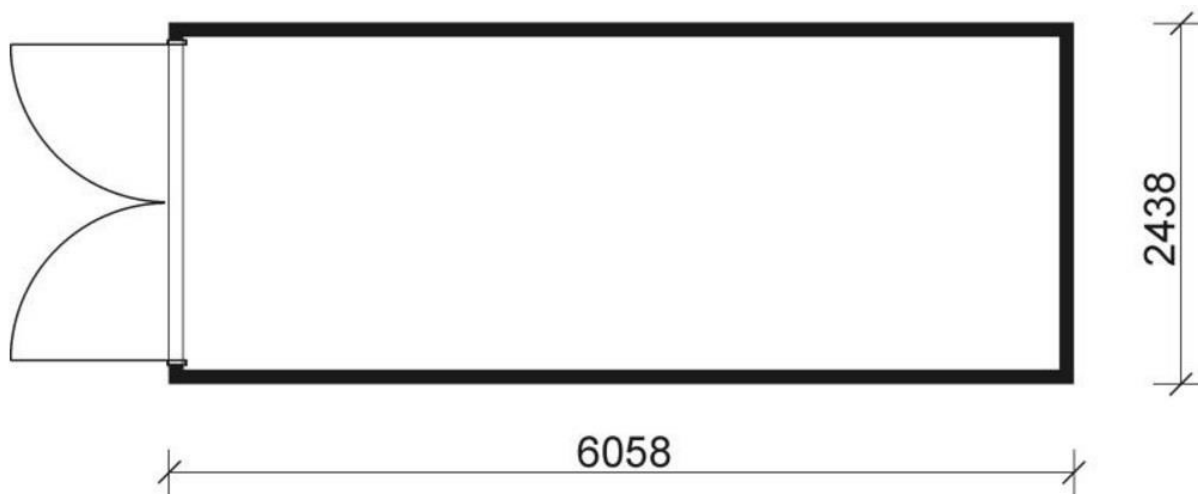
Obývateľná bunka OB6 - 2,3
